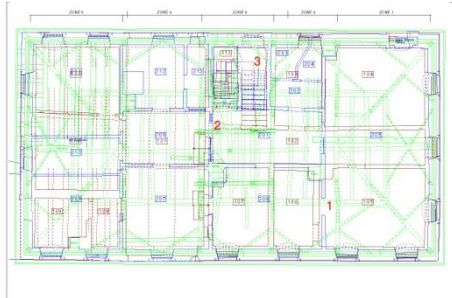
Übersichtspl. Grundrissüberlagerung EG: Braun, 1OG: Blau, DG: Grün
